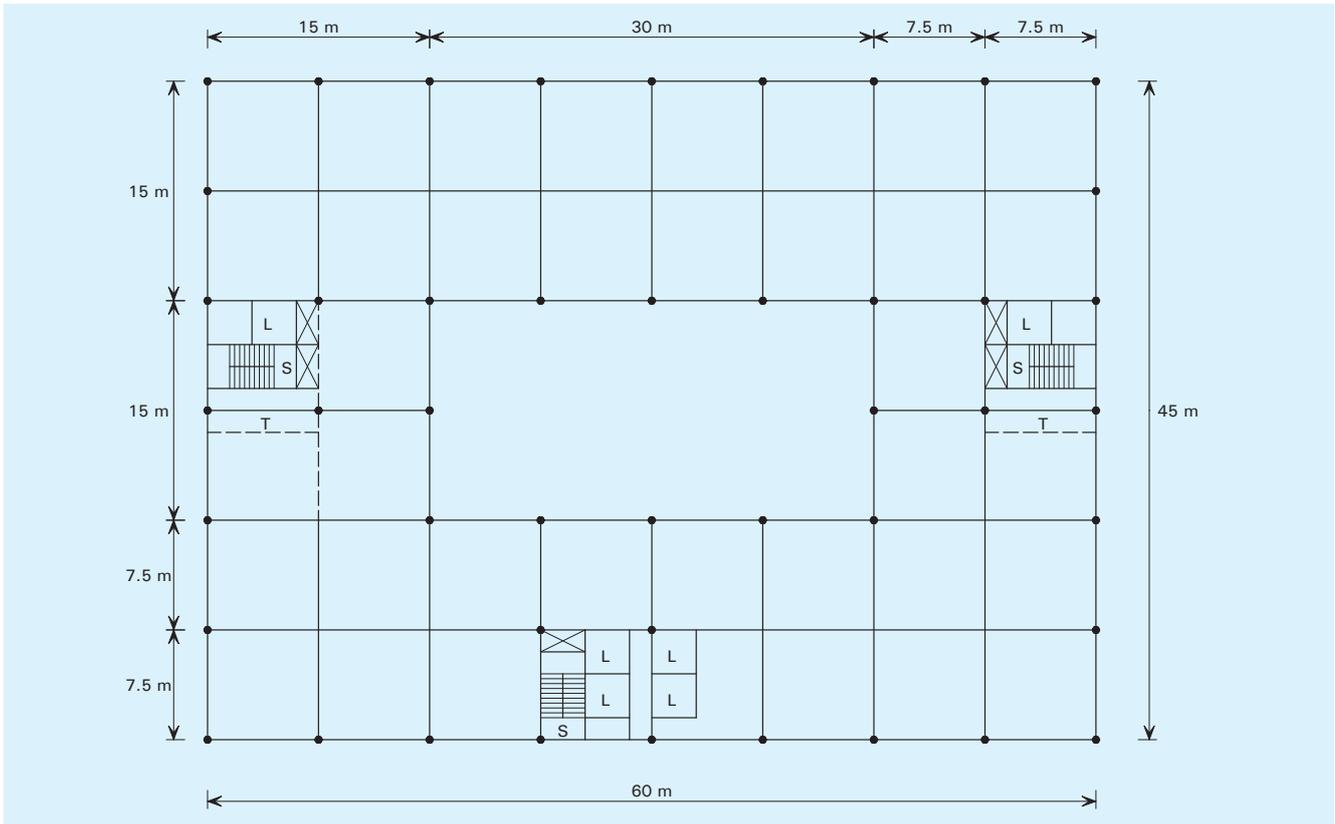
Сетка колонн для большепролетного перекрытия в здании с кондиционированием воздуха
